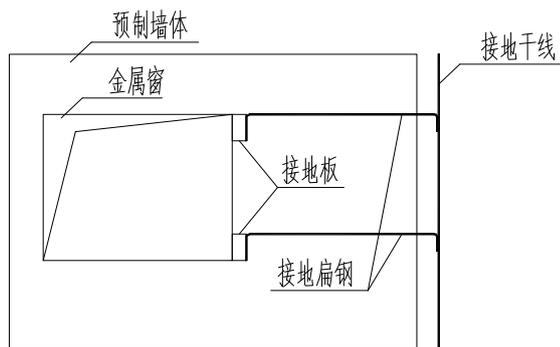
墙门窗的接地板在预制外墙内的安装方式平面图
